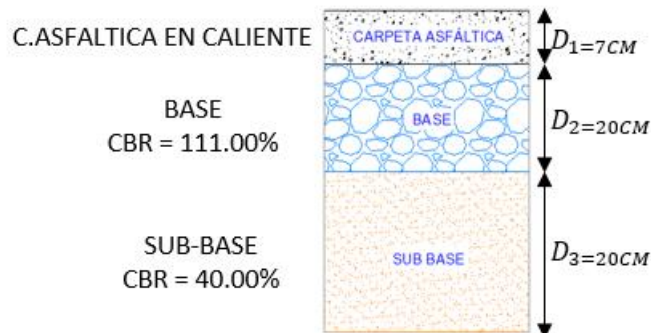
Espesores de pavimento con material de cantera de cantera
